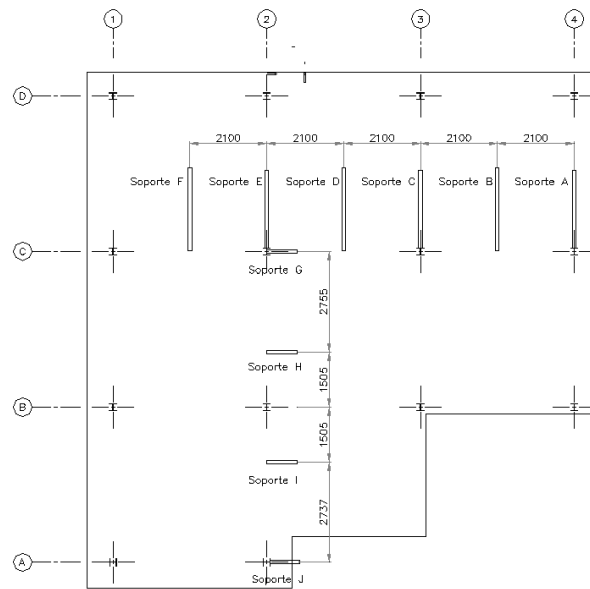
Posición de soporte de tubería en el nivel 3000.
